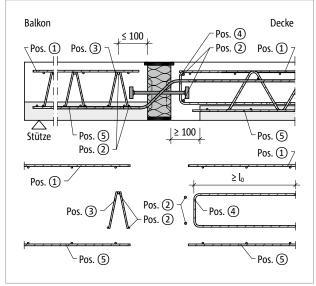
Schöck Isokorb® T Typ QP: Bauseitige Bewehrung mit Gitterträger
